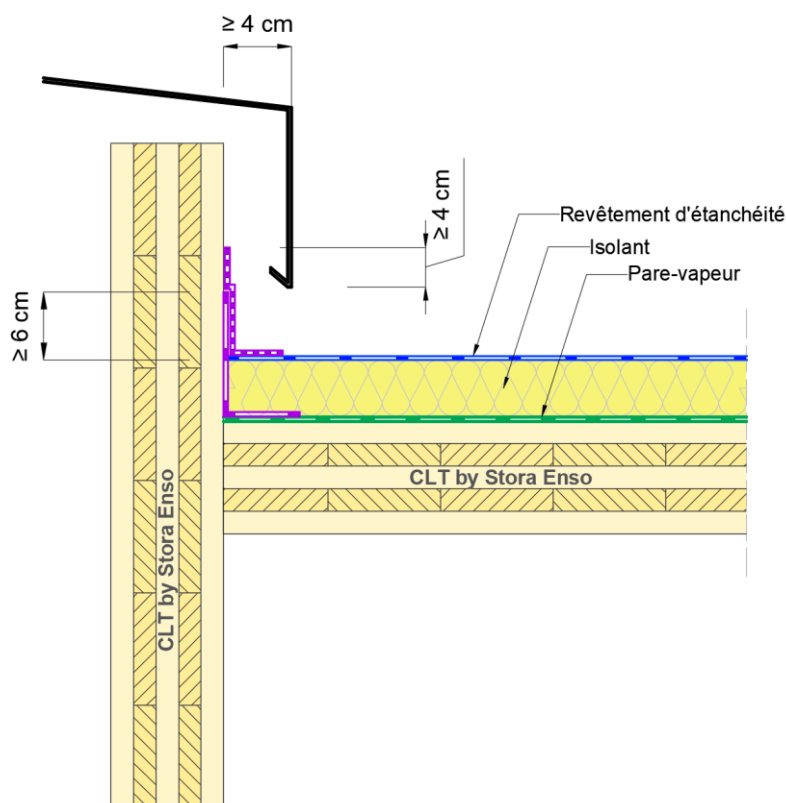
Principe de relevé d'étanchéité (exemple en toiture chaude) - coupe perpendiculaire à la pente.
